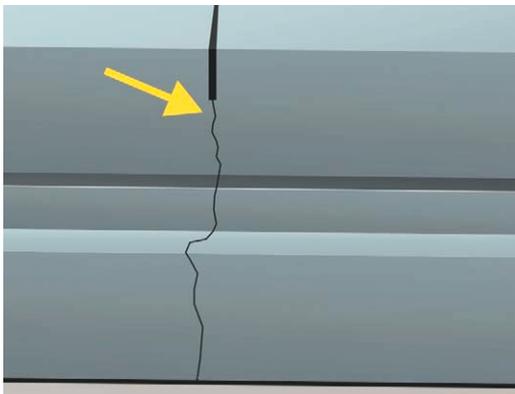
Junta transversal de retração serrada. Nota-se a fissura induzida
